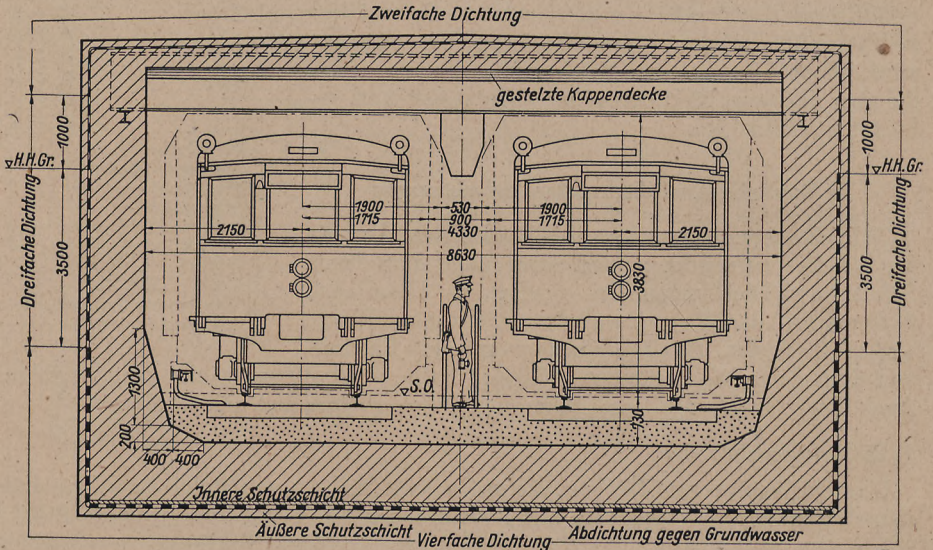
Tunnelquerschnitt einer Untergrundbahn
